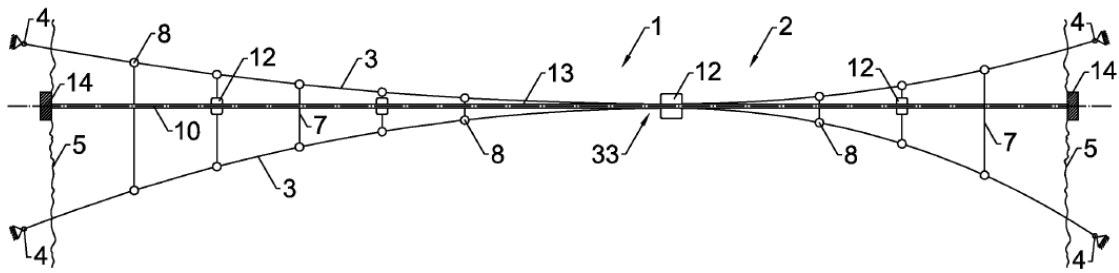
Grundriss, Variante 4 (Kollegger, et al., 2015)
